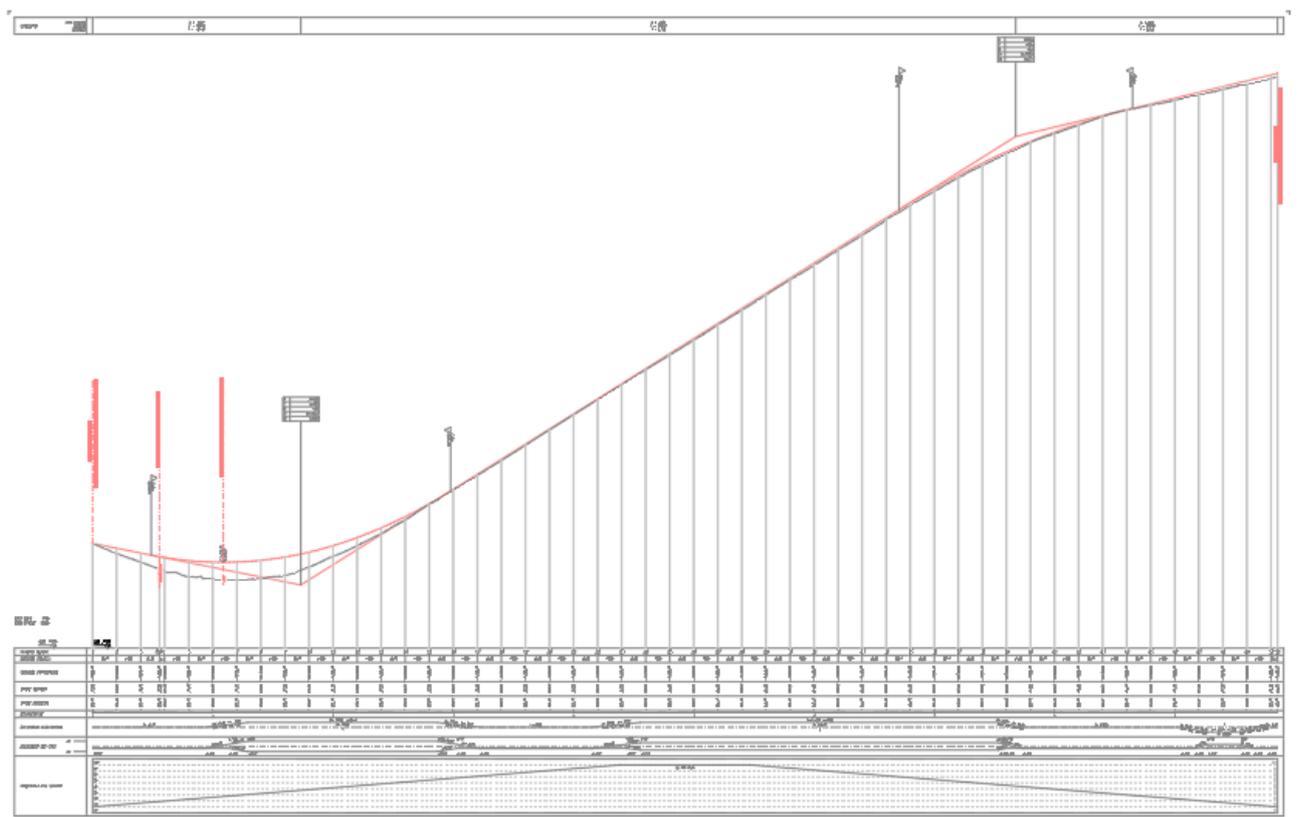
Profilo longitudinale del tratto stradale di adeguamento in sede
